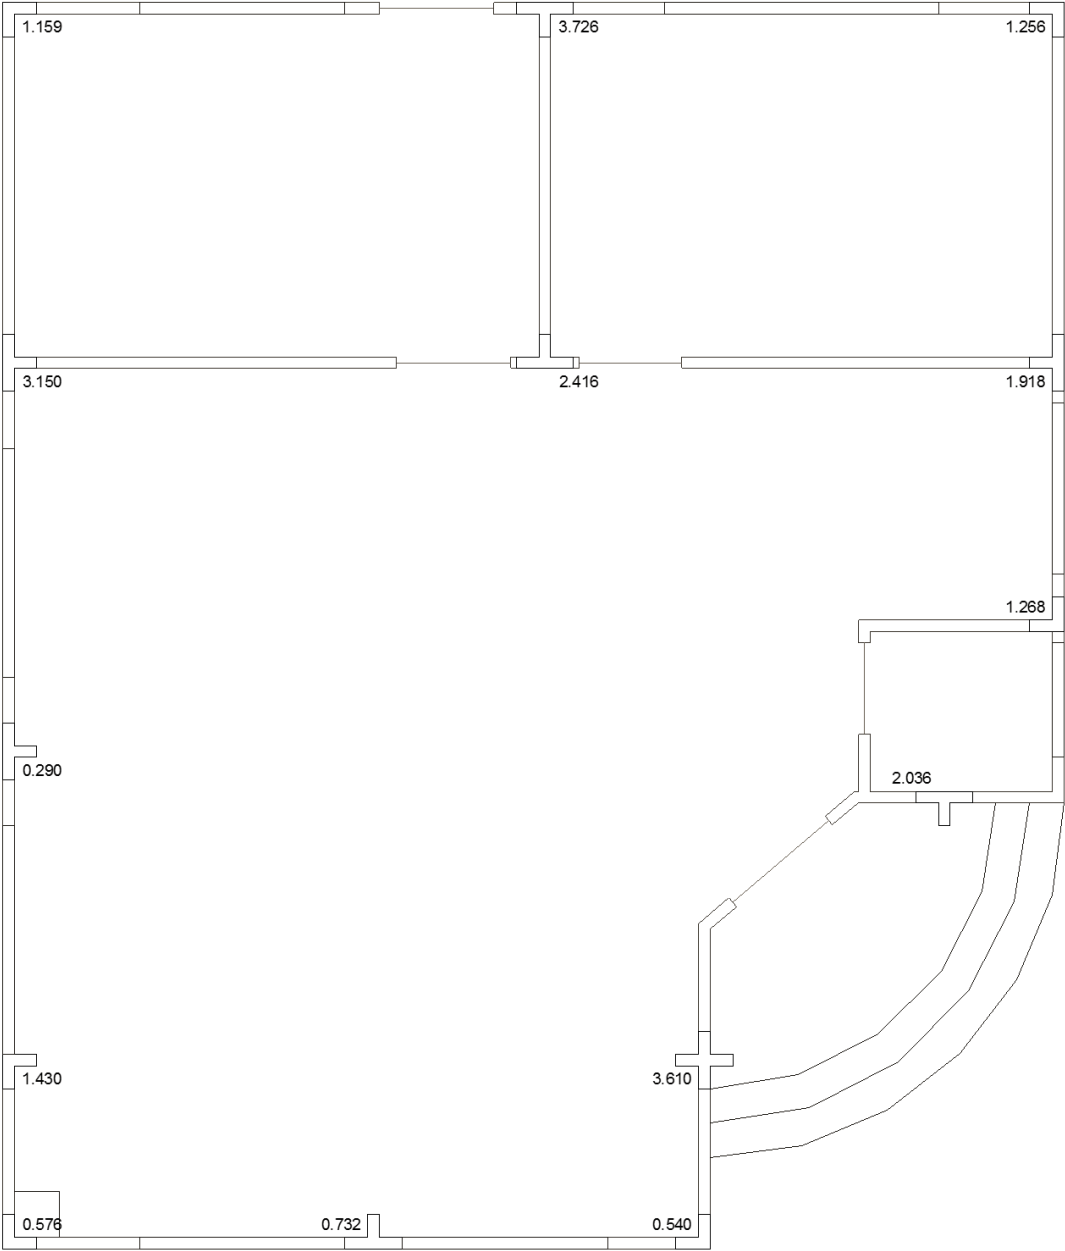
Carga de paredes sobre seudo columna en losa N+2.70m
